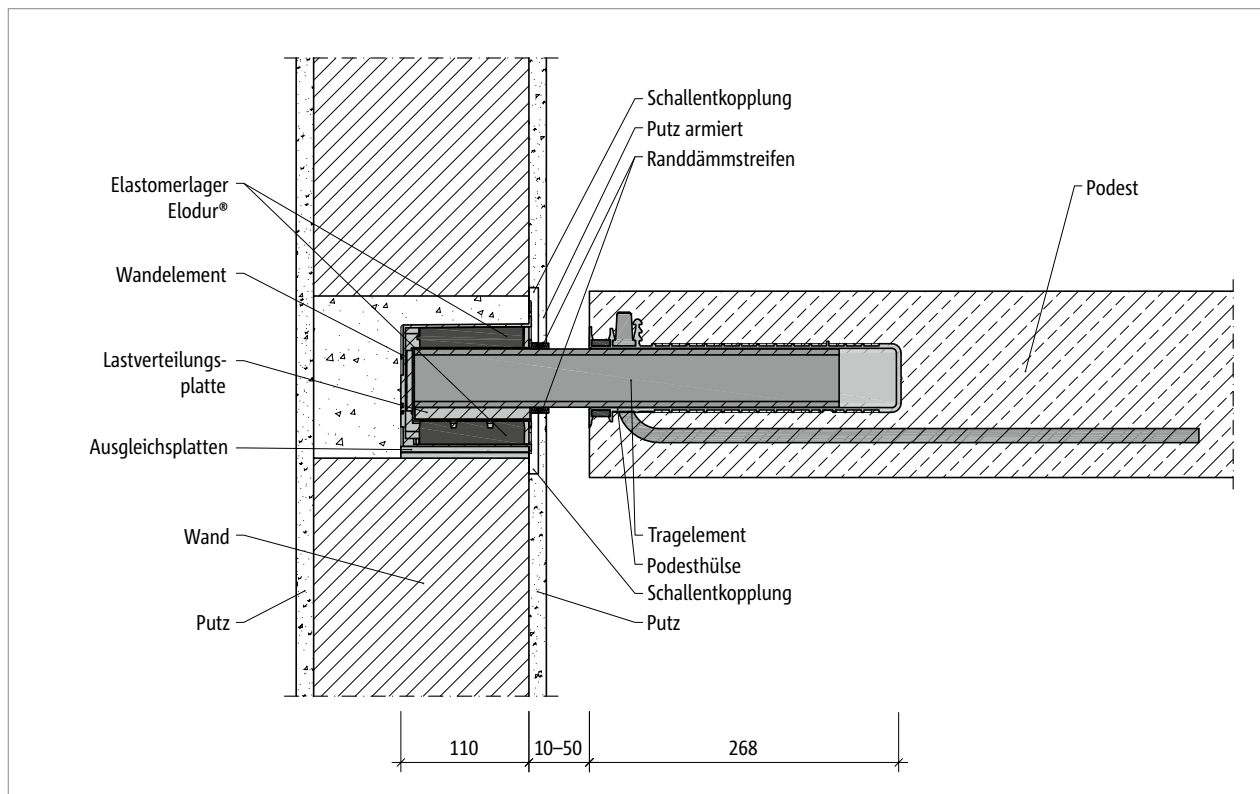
Schöck Tronsole® Typ P: Einbauschnitt mit Ortbetonpodest und Luftfuge
